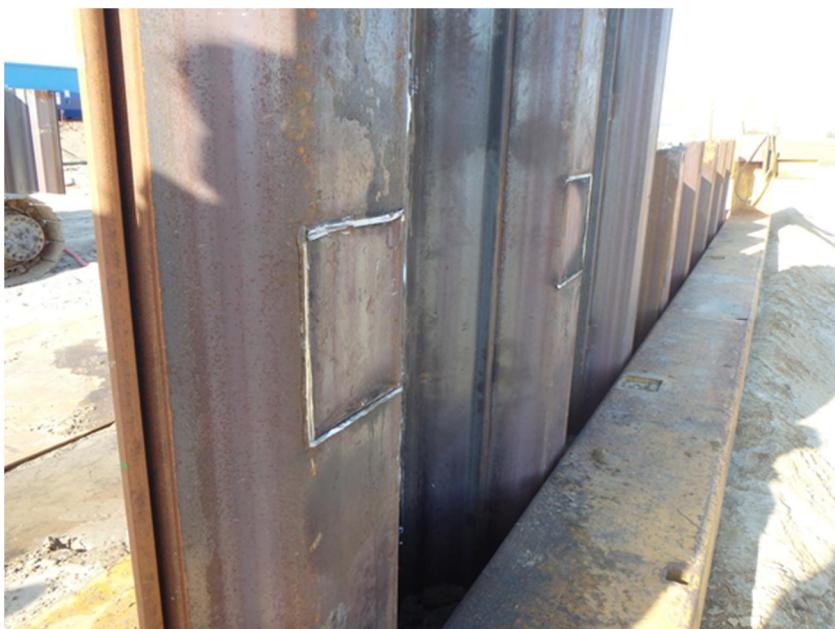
Vooraanzicht geïnstrumenteerde damwandplank na verwijderen verstijvingsplaat
